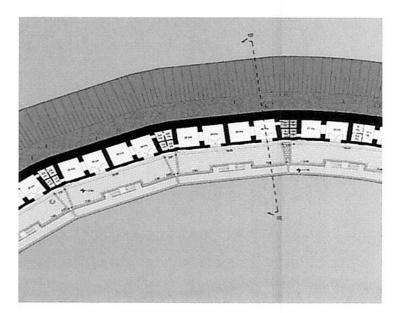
Stralcio pianta architettonica del molo sopraflutto "Caves a bateaux"
